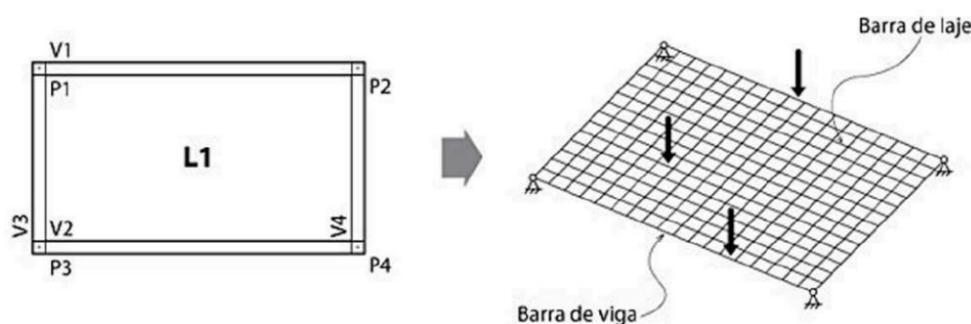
Grelhas de vigas e lajes. (Fonte: Kimura; 2018)
